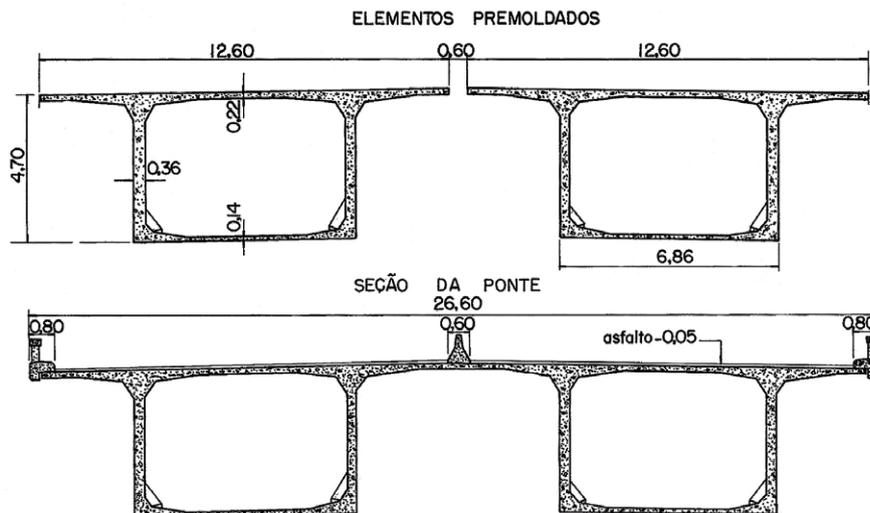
SEÇÃO MUITO SIMPLES DO PROJETO. ALTA CONSTANTE DE VIGA 4.7 E ESBELTEZ 1/17
